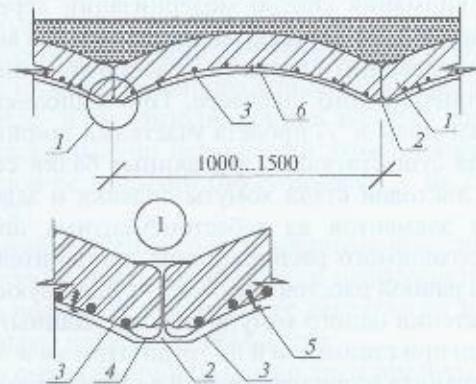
Усиление каменных перекрытий наращиванием железобетонной арочной плиты снизу:
